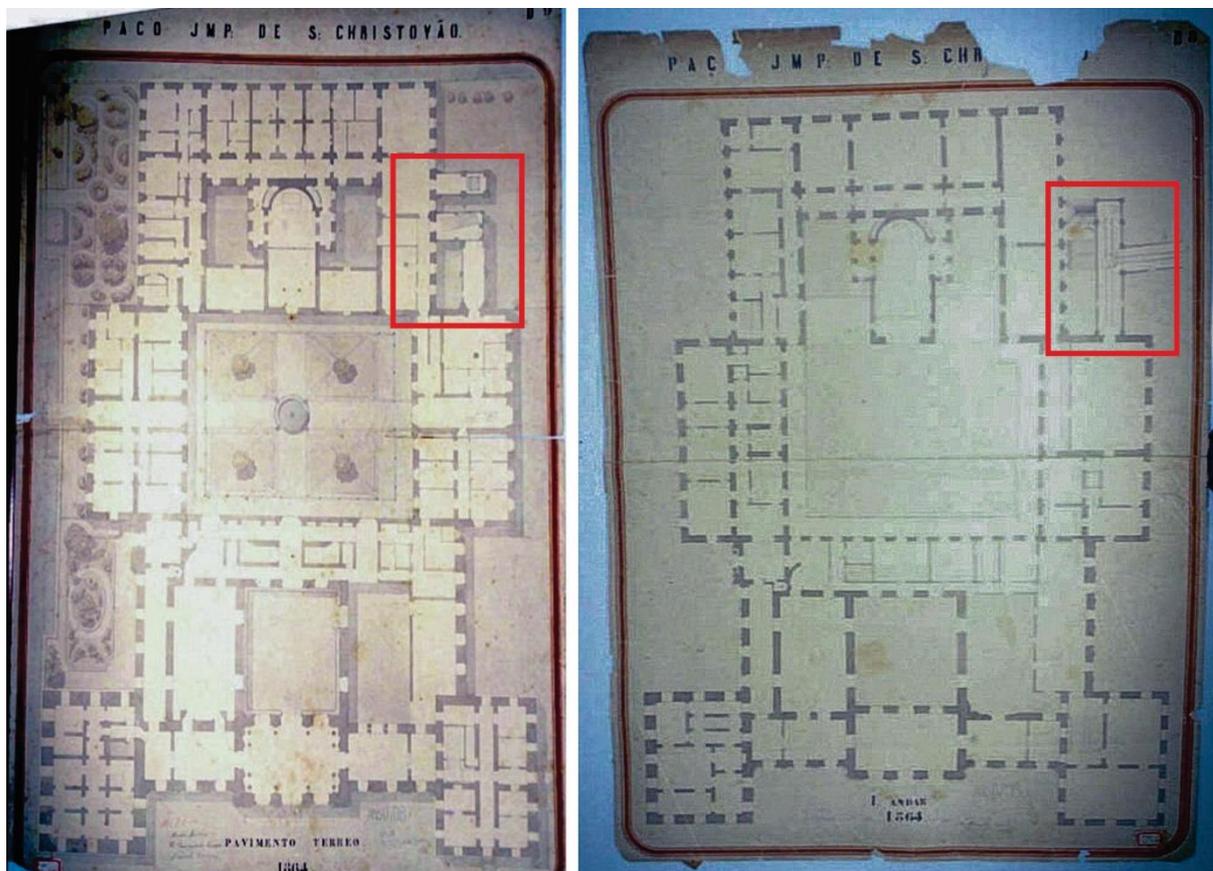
Planta baixa do 1º e 2º Pavimento Paço em 1864 com destaque para conjunto de blocos anexos ao Paço.
